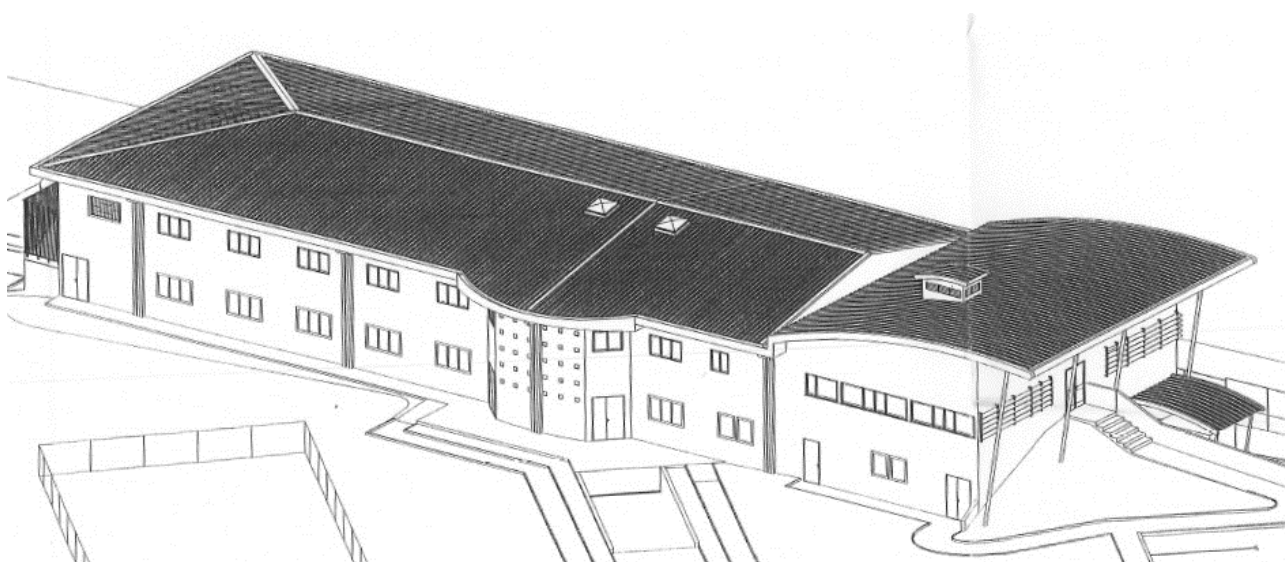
Vue d'ensemble du bâtiment multi-techniques :
